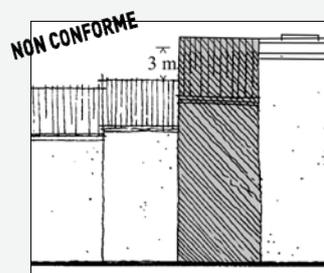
C : projet non conforme : la façade avant et la toiture dépassent de plus de 3 mètres le profil mitoyen le plus bas, sans pour autant dépasser le profil mitoyen le plus haut.
